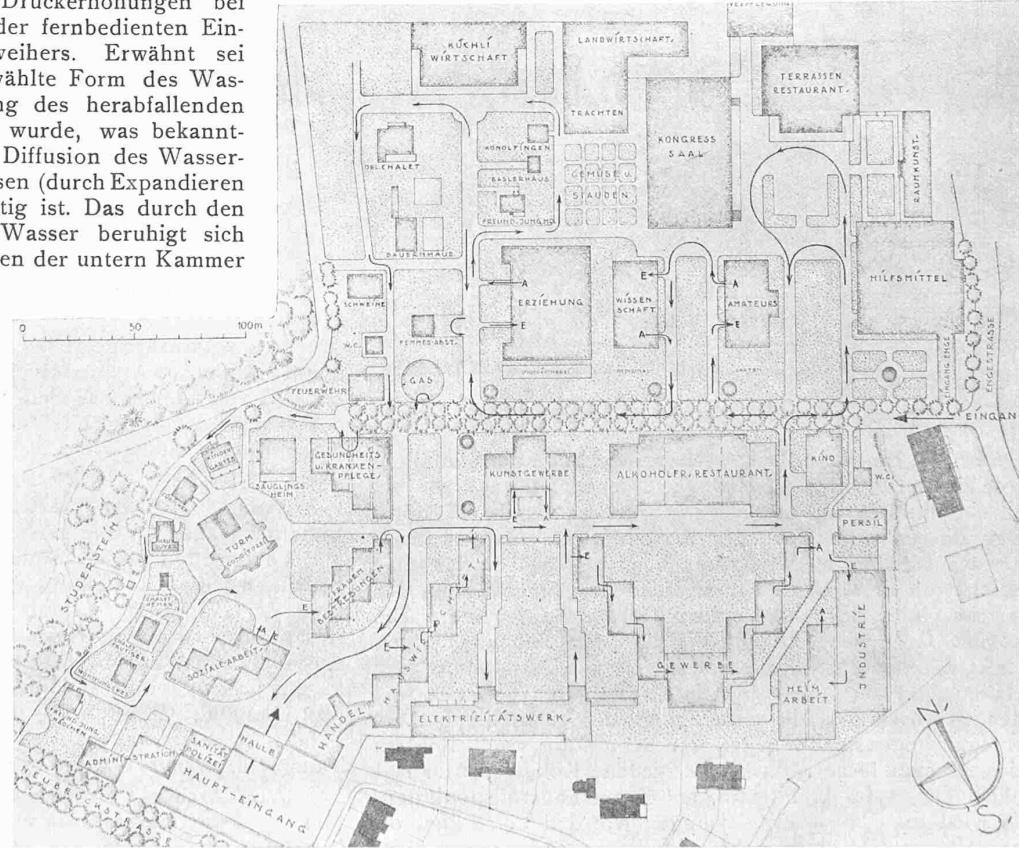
Lageplan der „Saffa“, Schweizer. Ausstellung für Frauenarbeit. — 1 : 3000.
